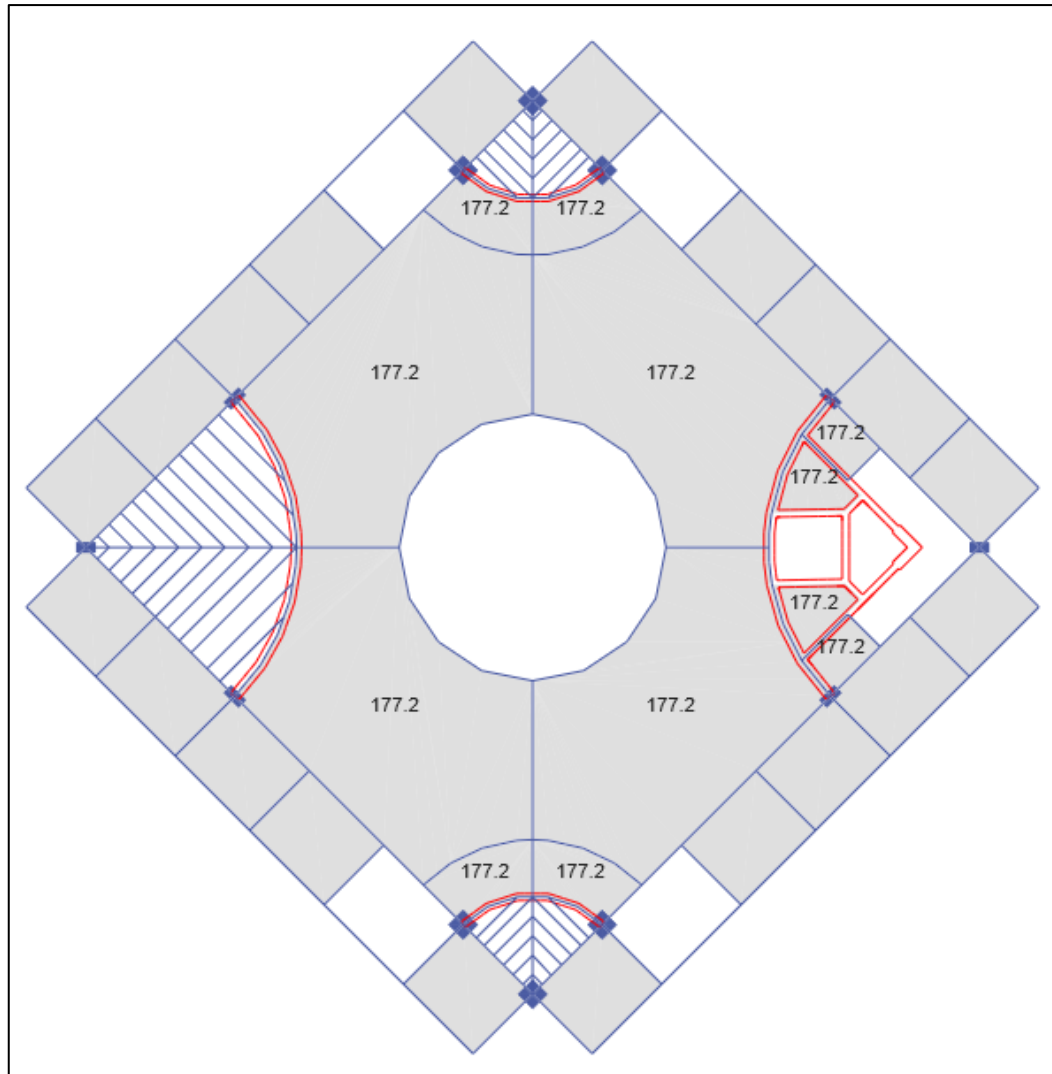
Cargas No Estructurales 1er piso - Losas de Hormigón (kg/m²)
